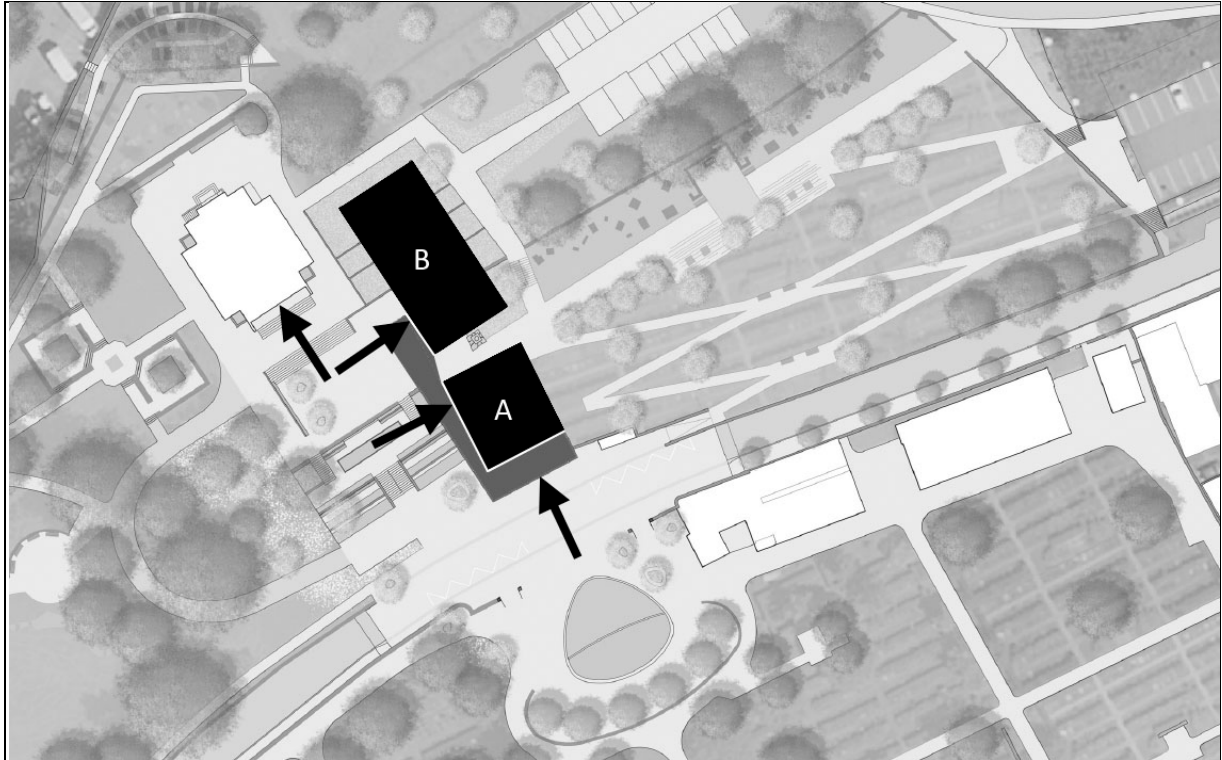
Plan de situation (auteur : Bureau paysagiste :Belandscape)
